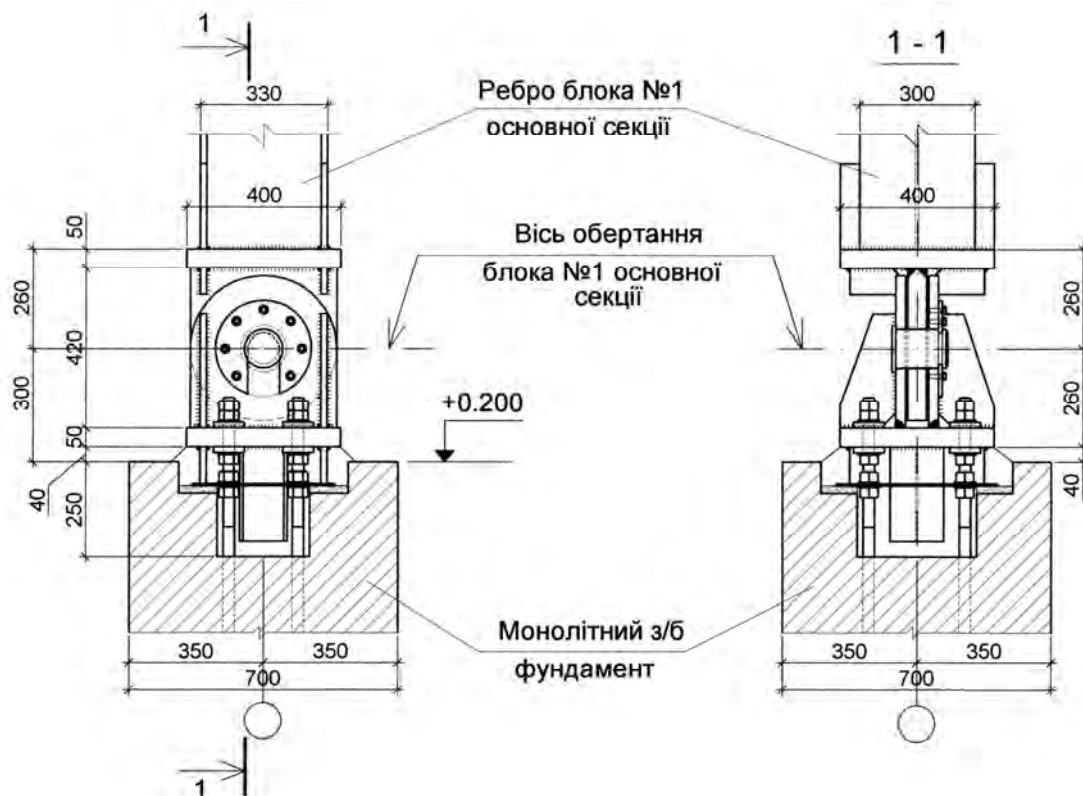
Шарнірне кріплення ребер напіварок до фундаменту
